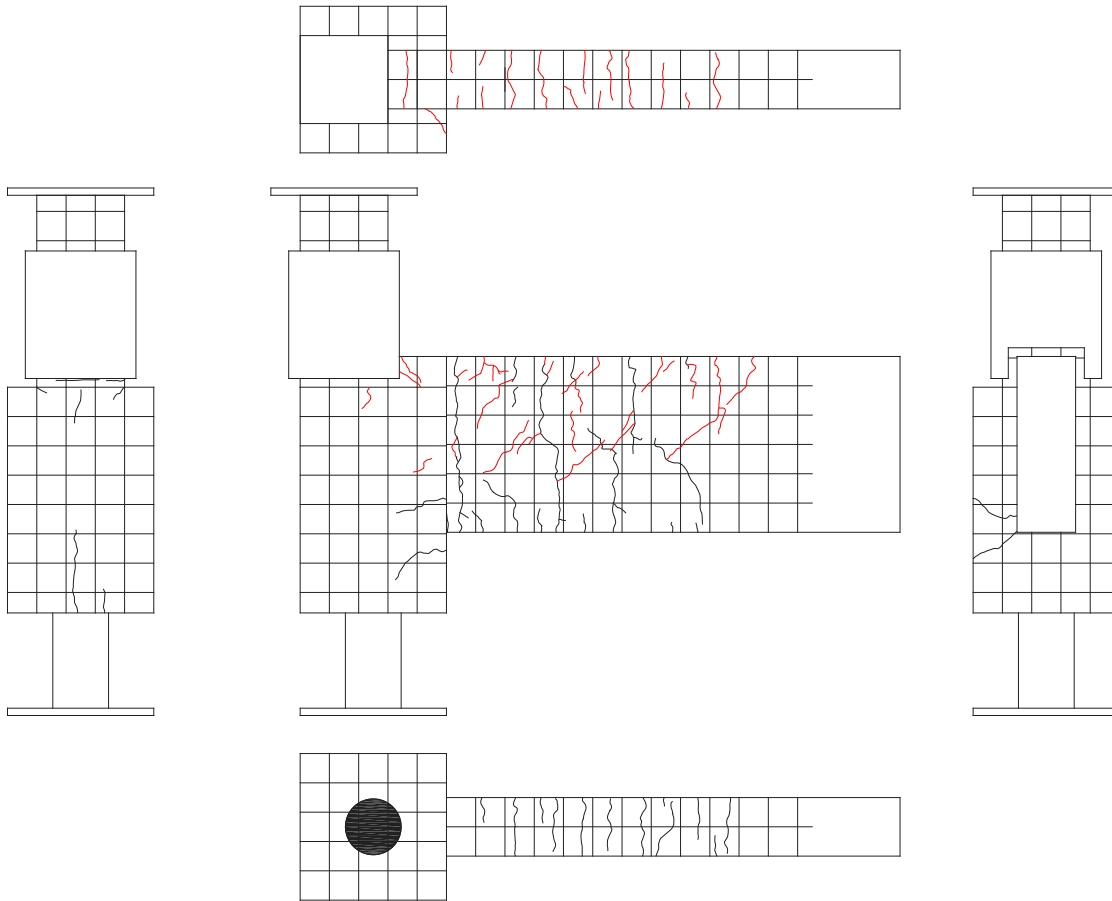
3. 93 試験体 C-2 ひび割れ状況 (2Cycle)
